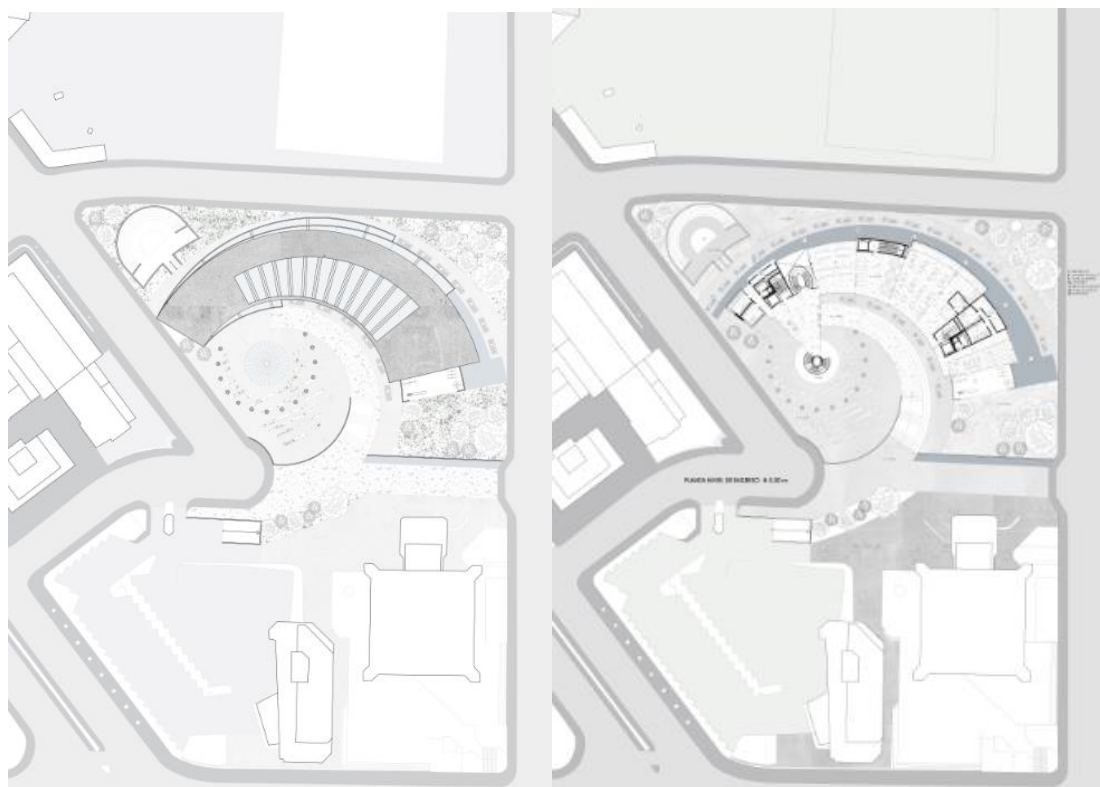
“Implantación y Planta nivel de ingreso” elaboración propia
